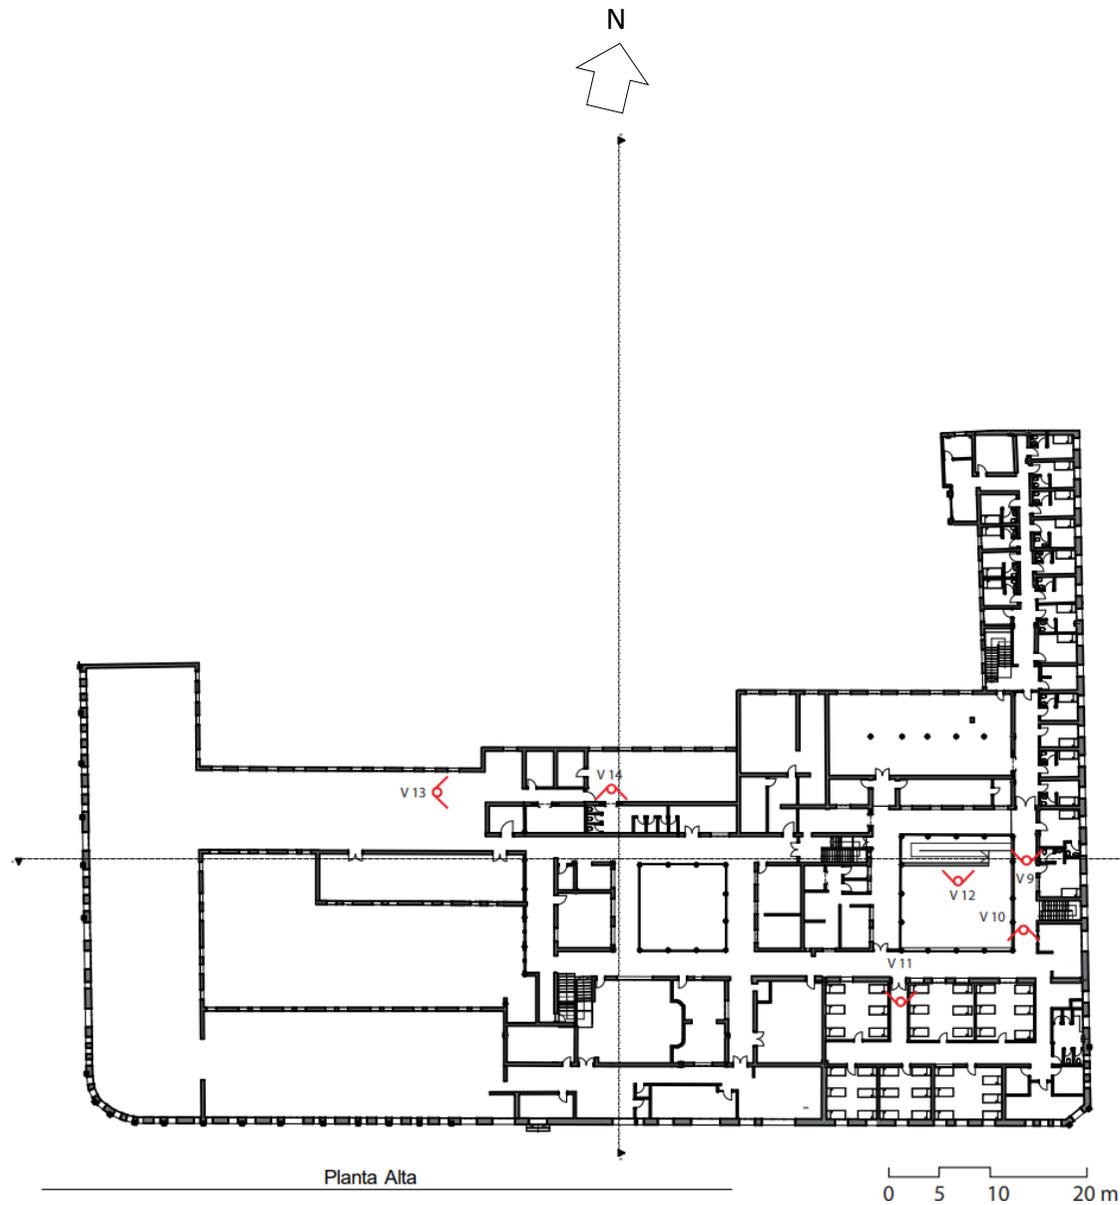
Planta alta "vistas" Hogar Cristo Rey.
